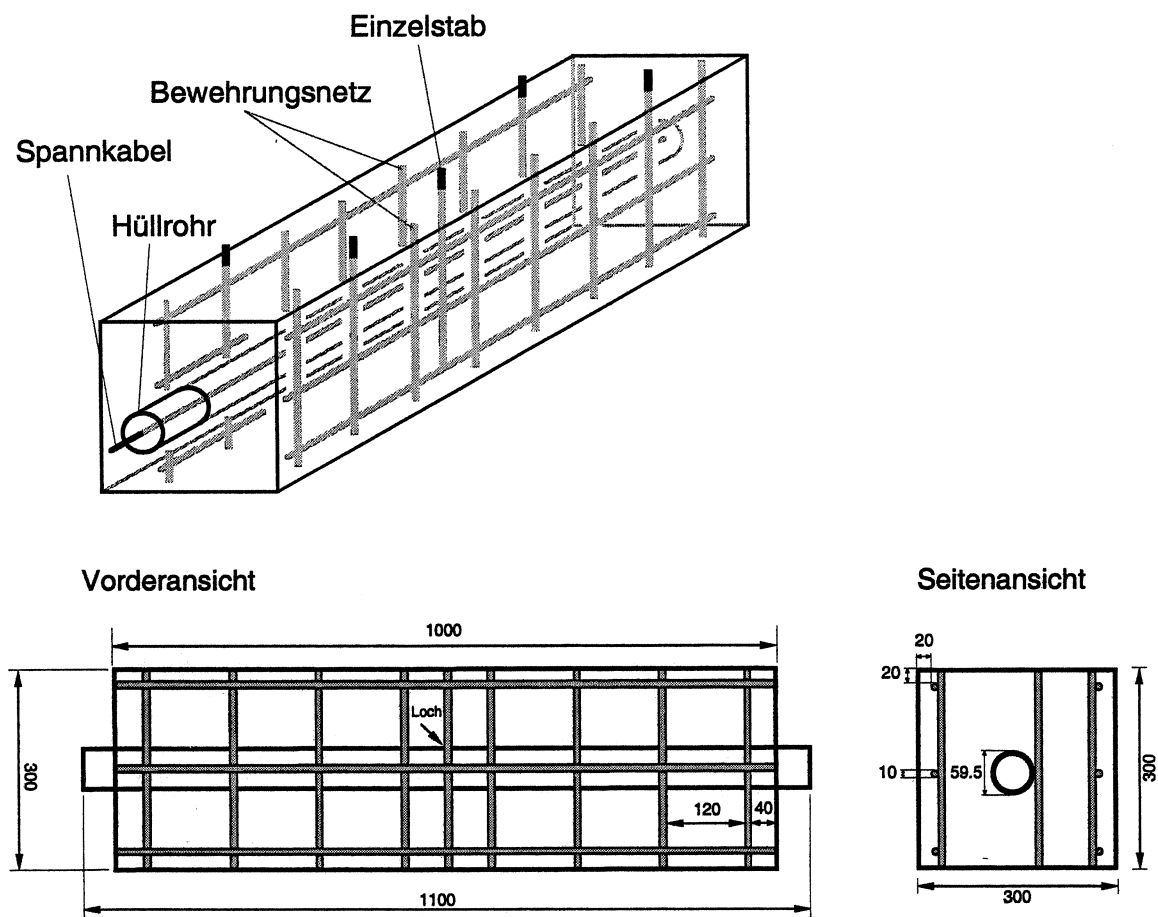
Betonprobekörper (alle Masse in mm)
